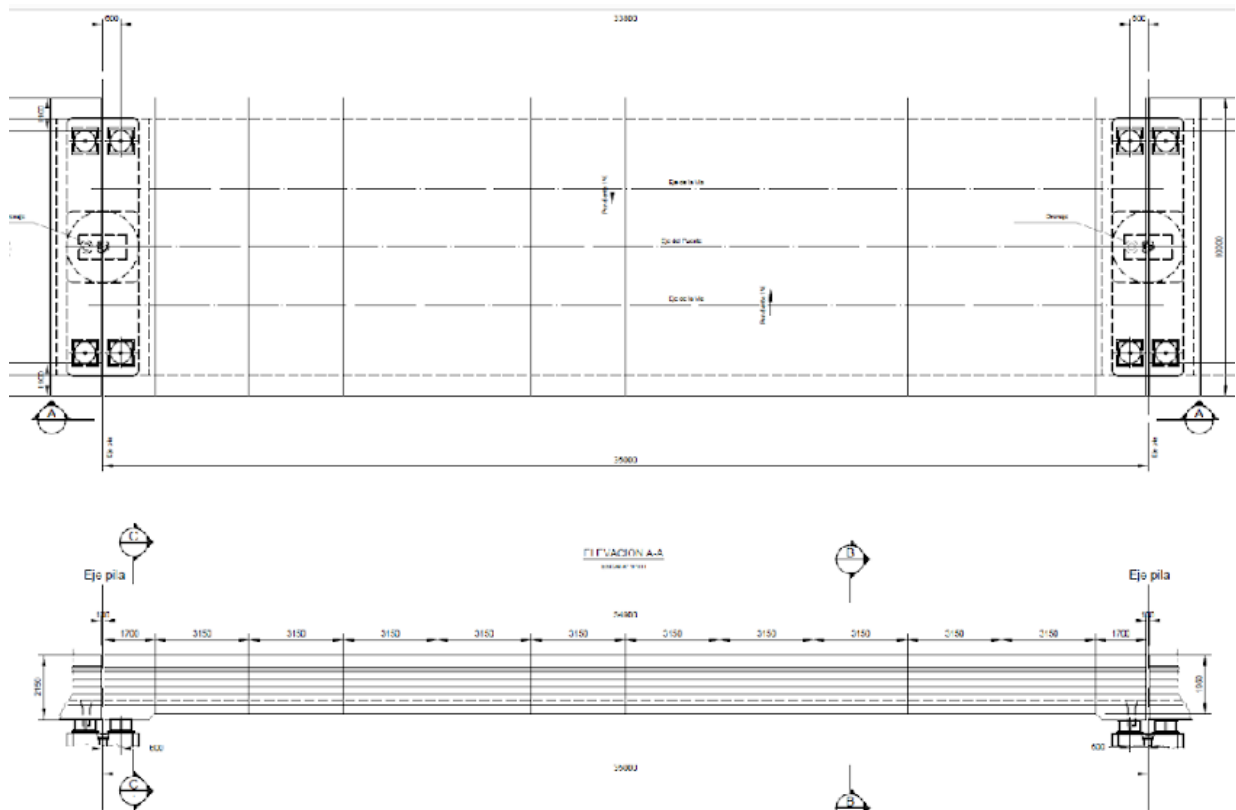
Tramo tipo Viaducto elevado vista en planta y elevación
